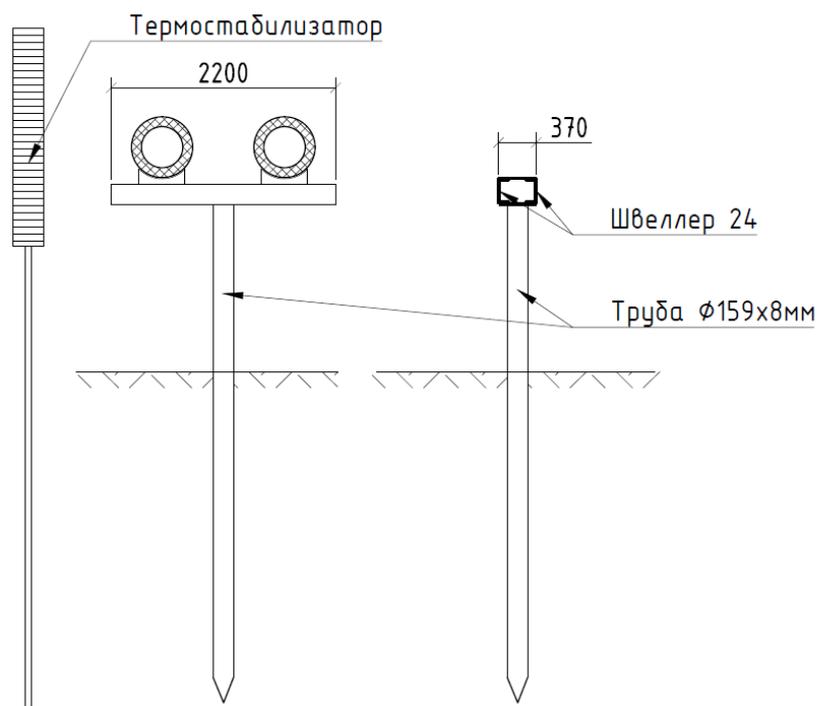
Схема устройства опор при надземной прокладке в вечномерзлых грунтах
